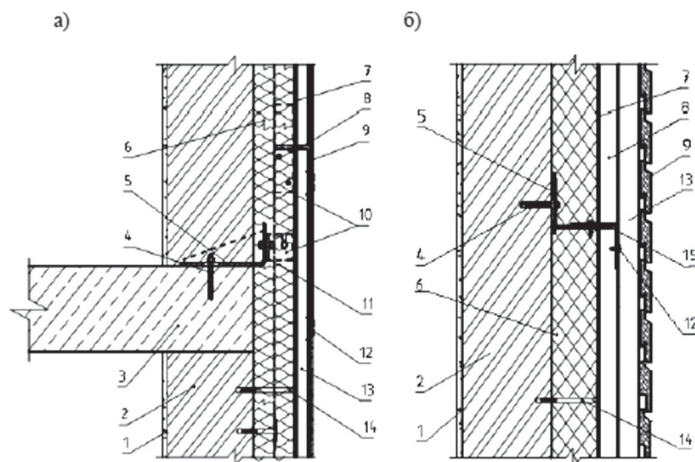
Конструктивна схема зовнішньої стіни з фасадною суцільною теплоізоляцією з опорядженням масивними (а) та легкими тонкошаровими (б) штукатурками:
